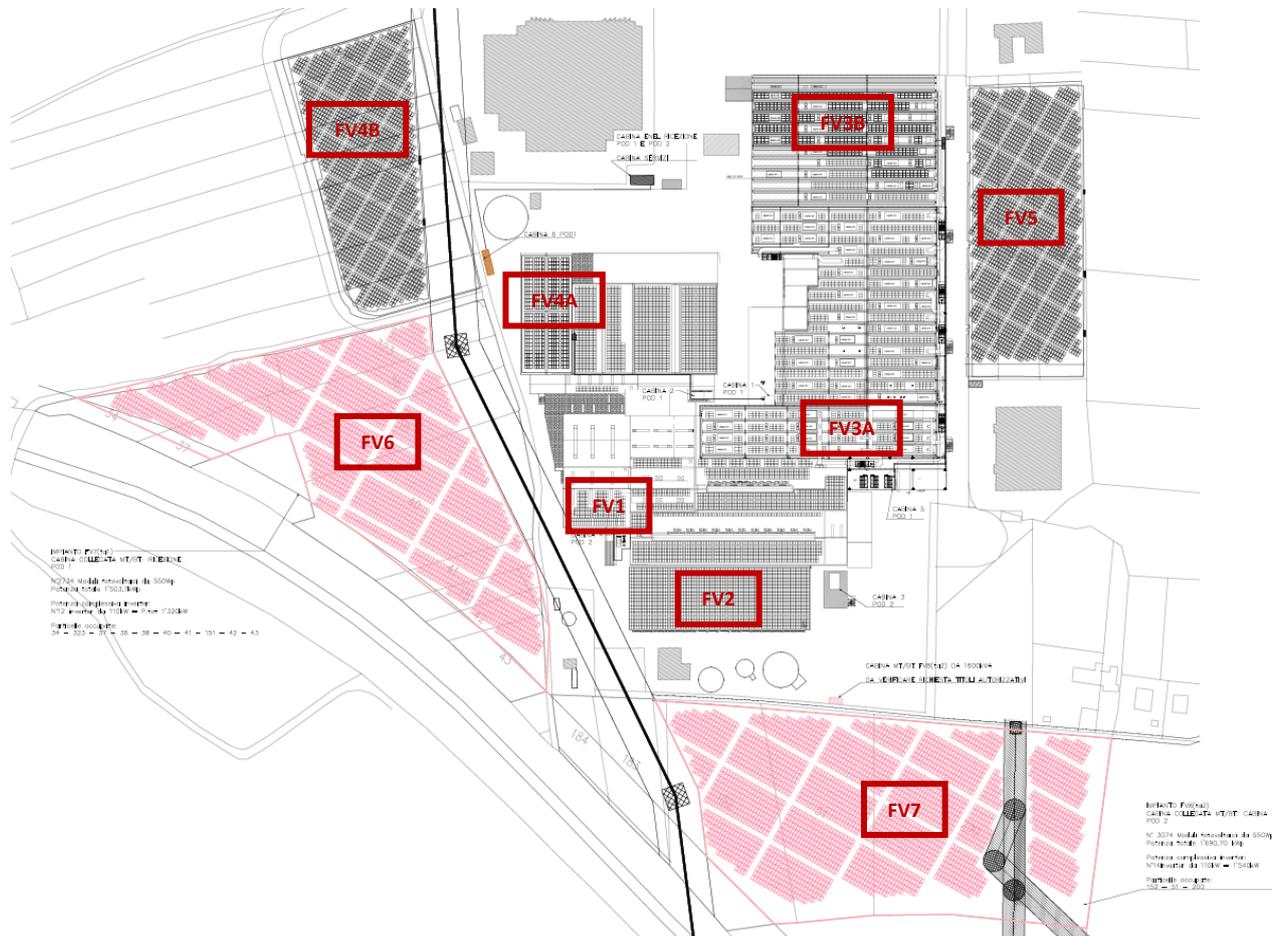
Planimetria dello stabilimento con indicata la posizione delle sezioni dell’impianto fotovoltaico.
